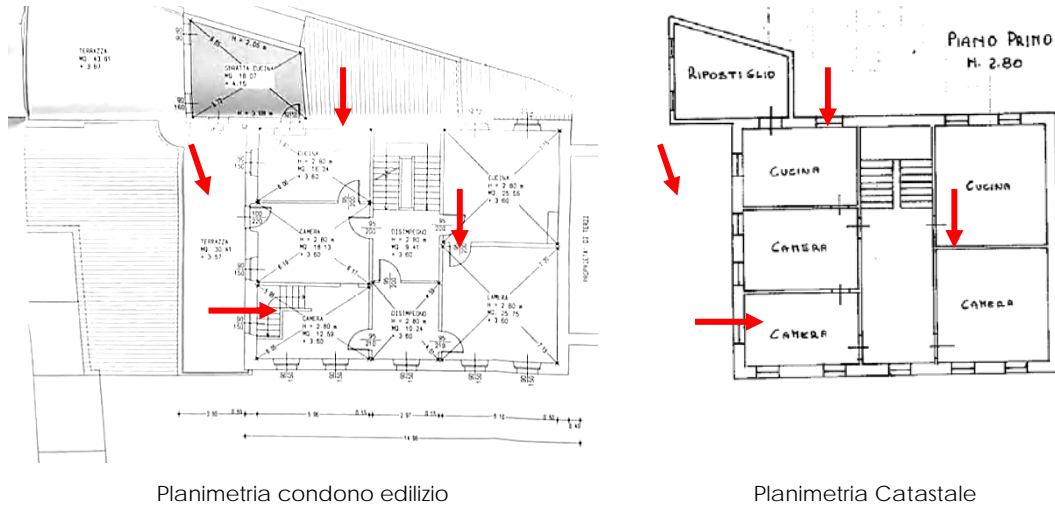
part. 587, sub. 2, abitazione e soffitta
